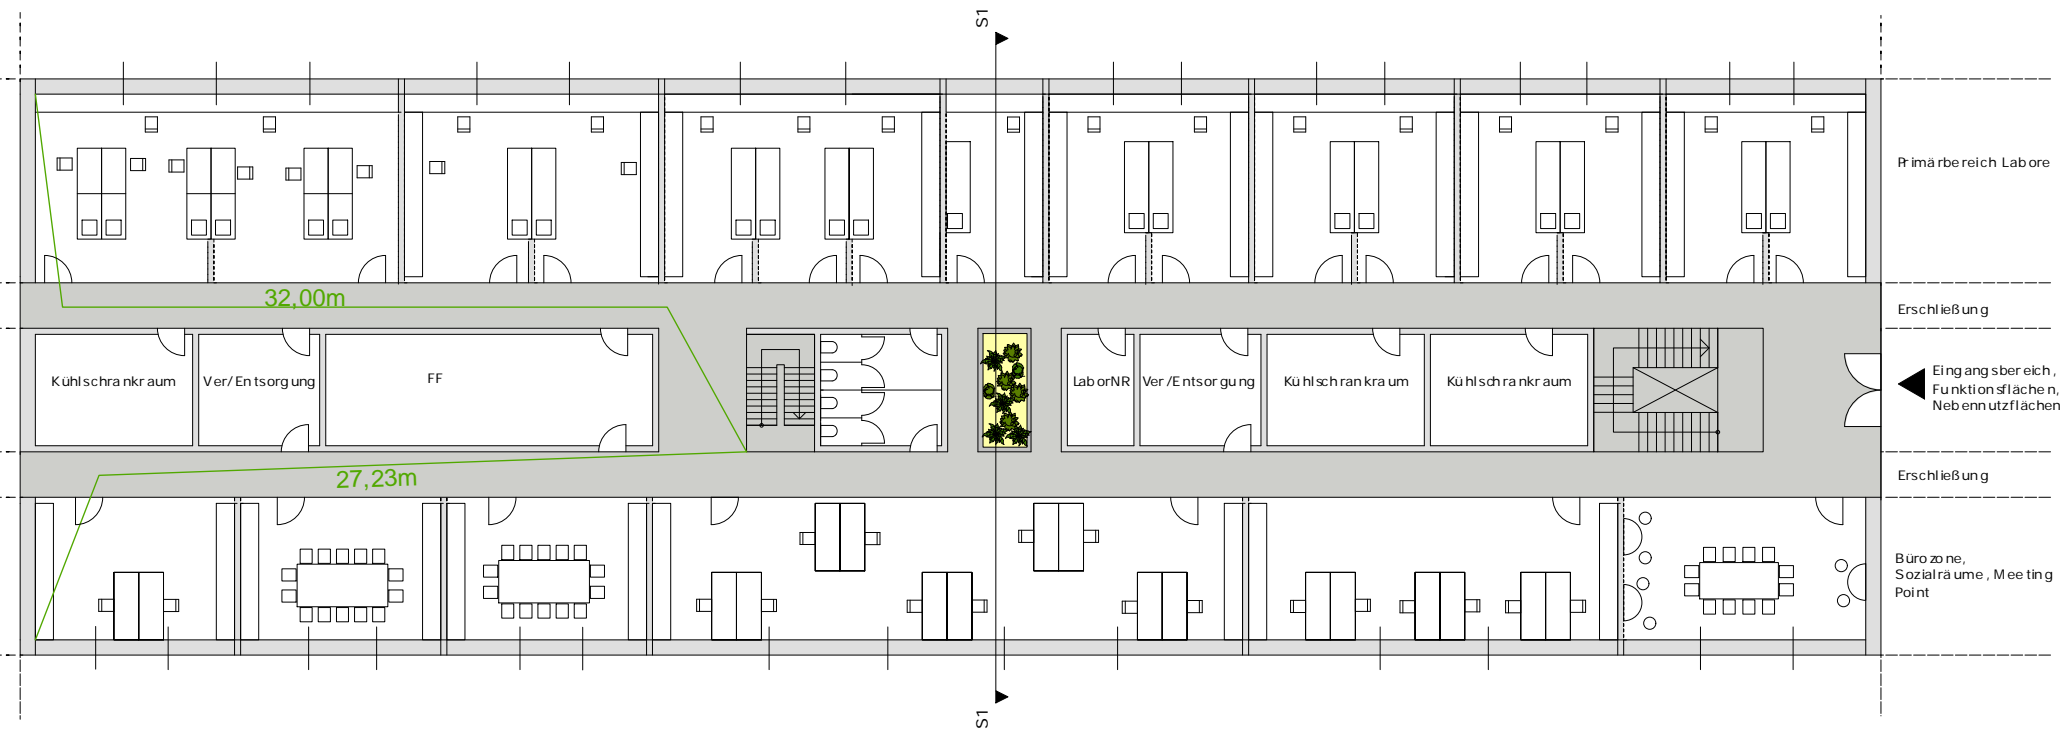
Auszug Forschung Grundriss M=1:250
